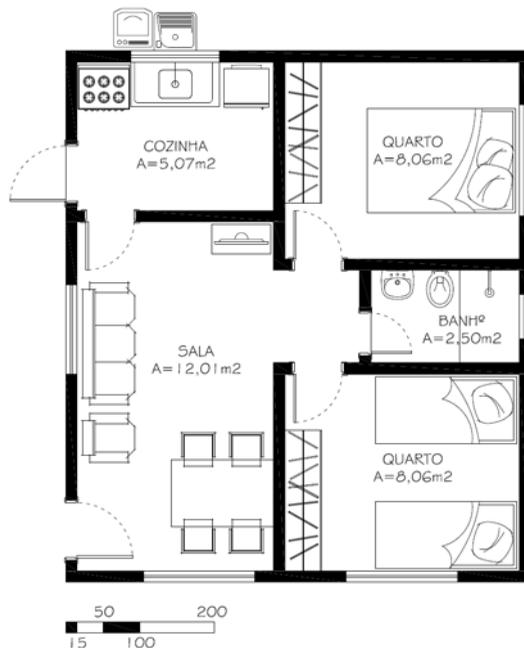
Planta baixa da casa original do residencial Santo Antônio. Leiaute conforme projeto aprovado na Prefeitura de Cuiabá.
